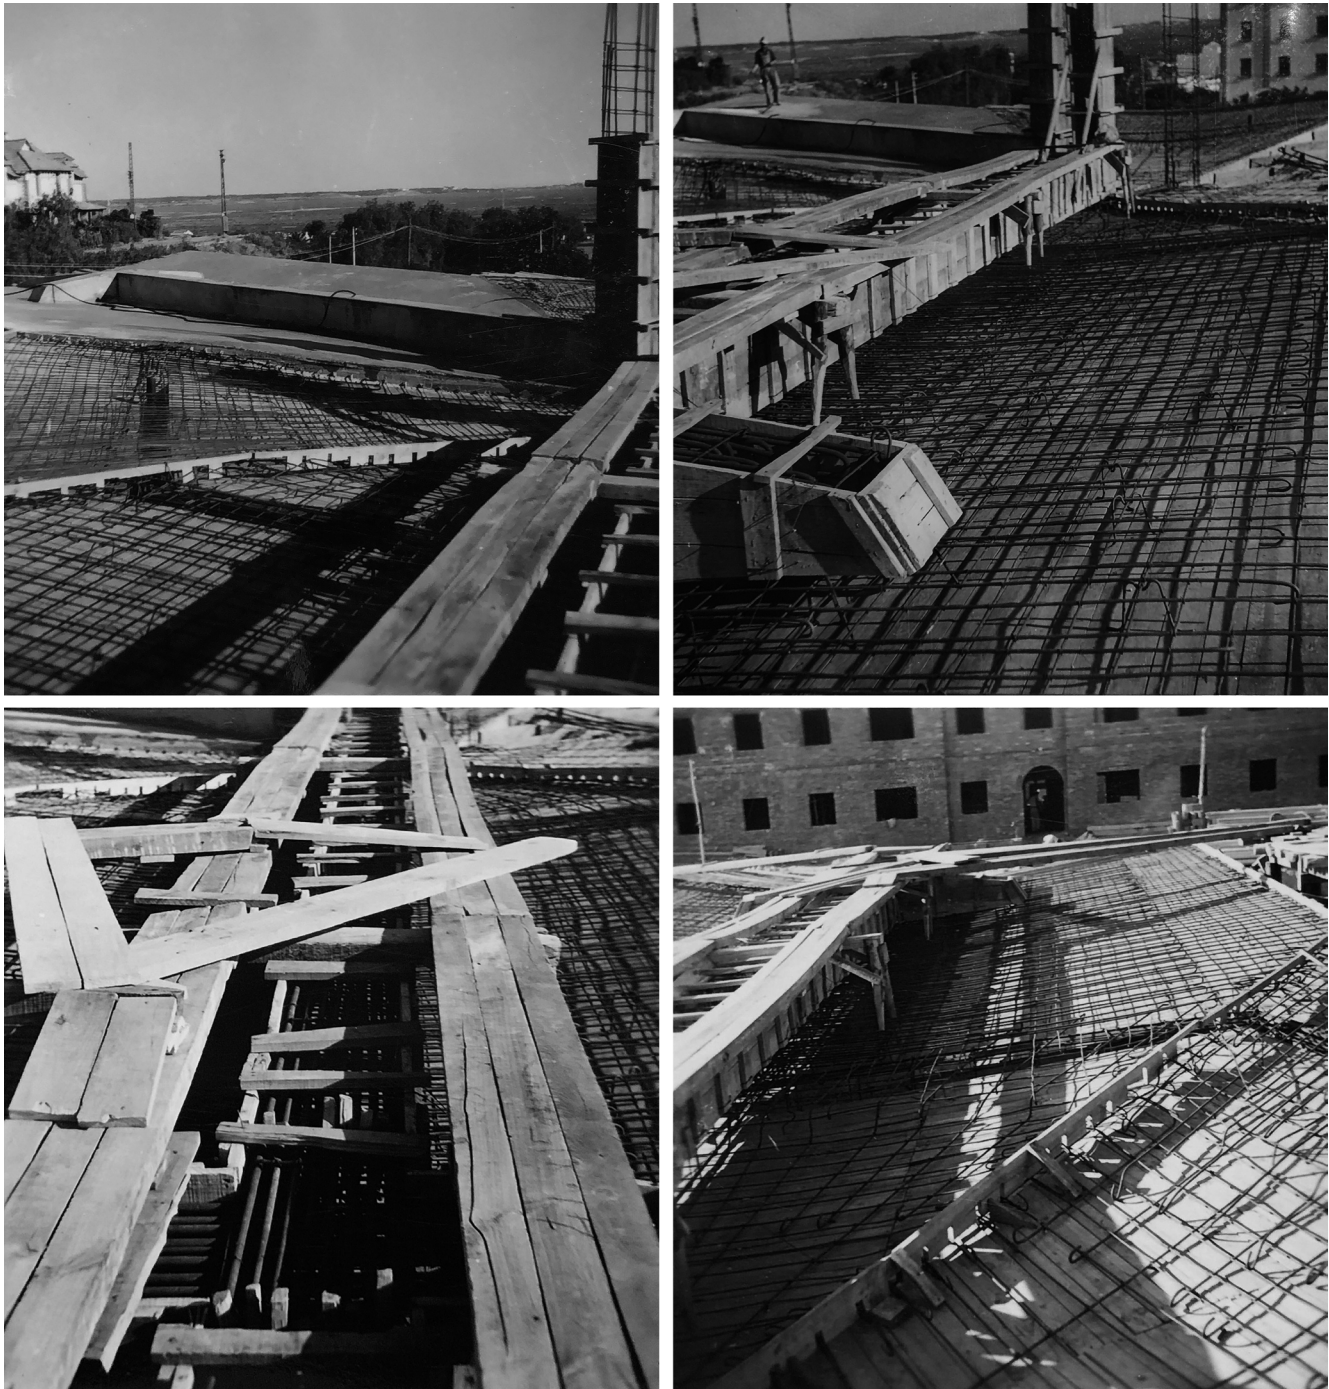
Proceso de obra: encofrados y armaduras previo al hormigonado de la cubierta. Fotografías Alejandro Herrero (c. 1958).
